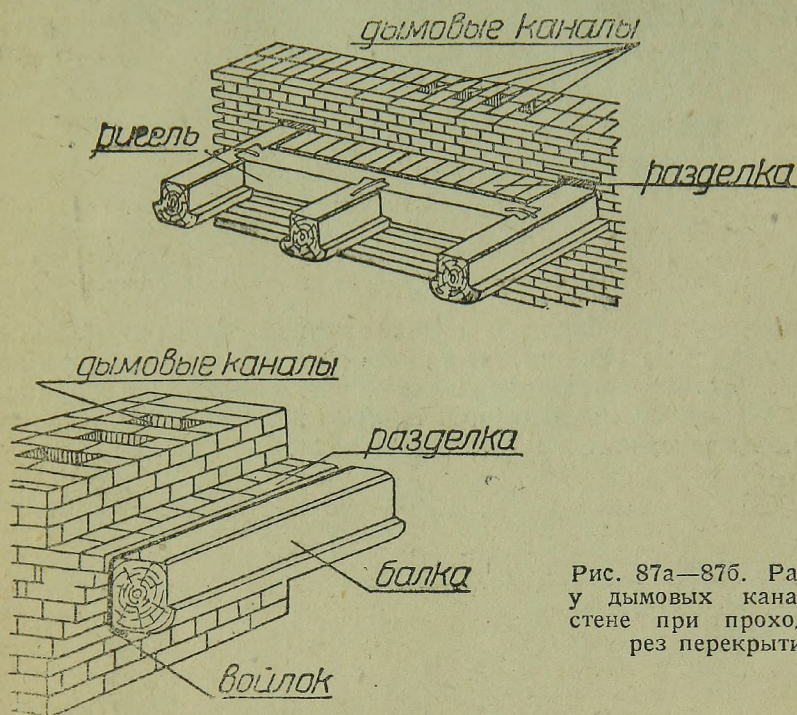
а—87б. Разделка у дымовых каналов в стене при проходе через перекрытие.
